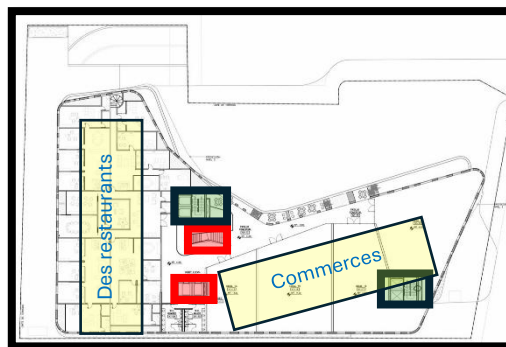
plan R+1 source : www.archdaily.com traite par les auteurs
